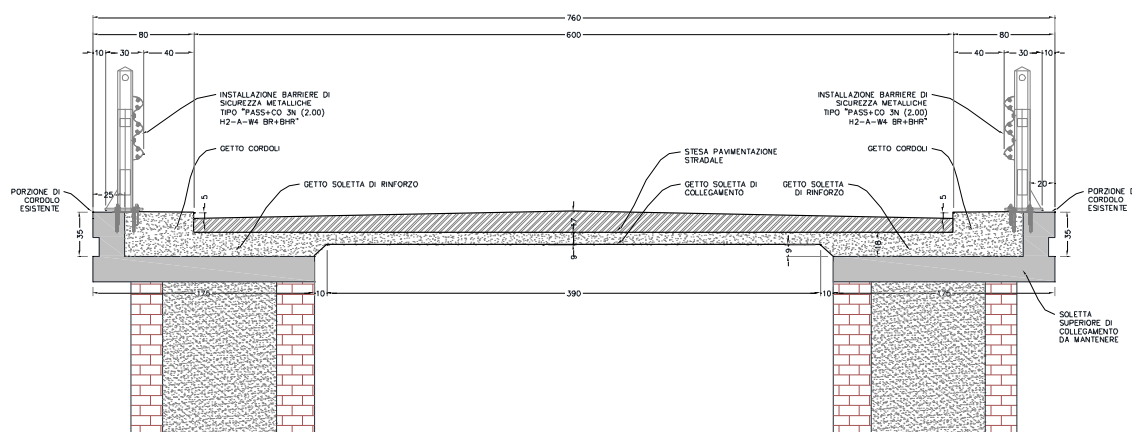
Sezione trasversale allo stato di progetto - tratti a tergo spalle
